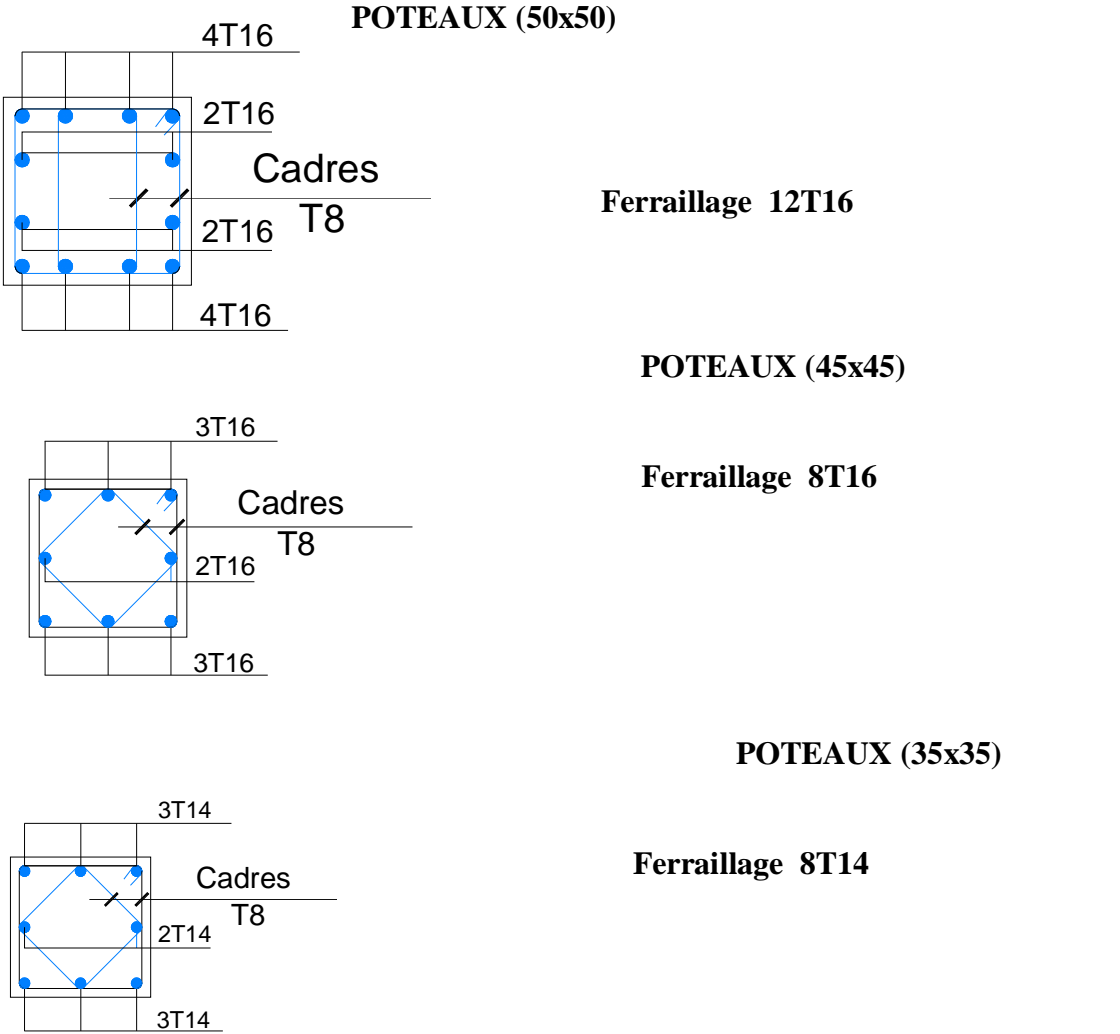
Dessin de ferrailages des sections des poteaux
